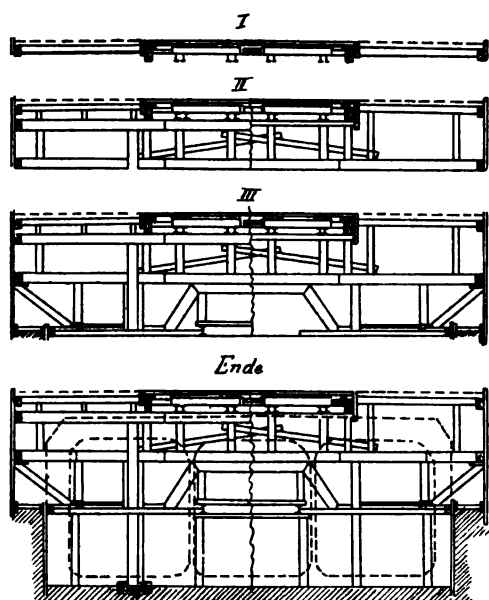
Einrüstungsstadien beim Bau der Untergrundbahn in New-York.
